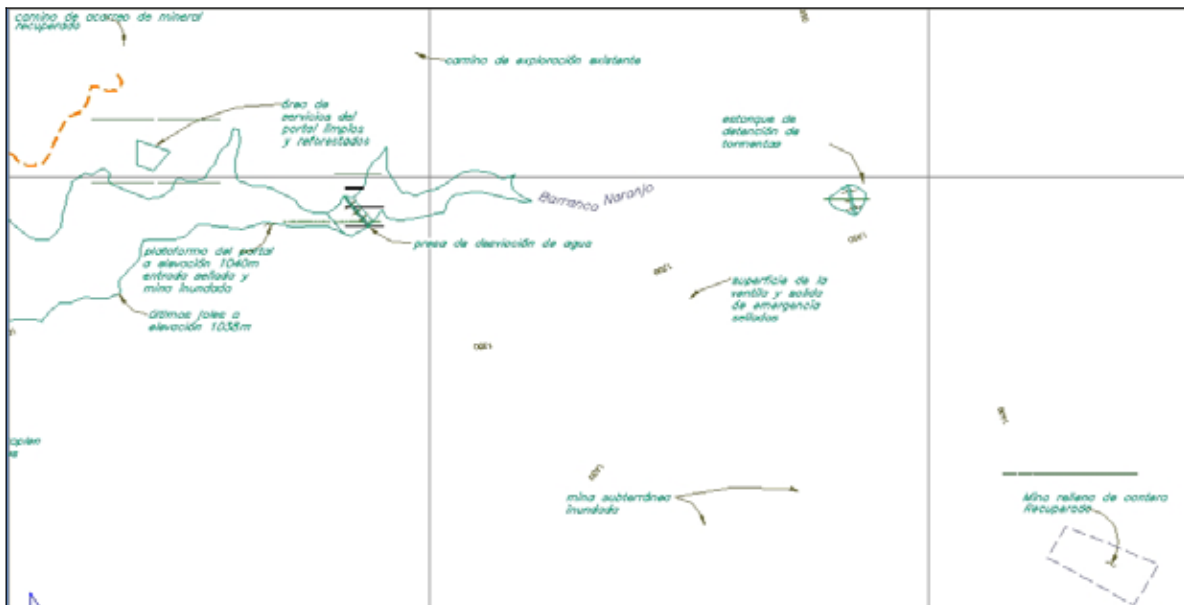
Otra sección del plano B34 que muestra el plan de cierre del proyecto.
